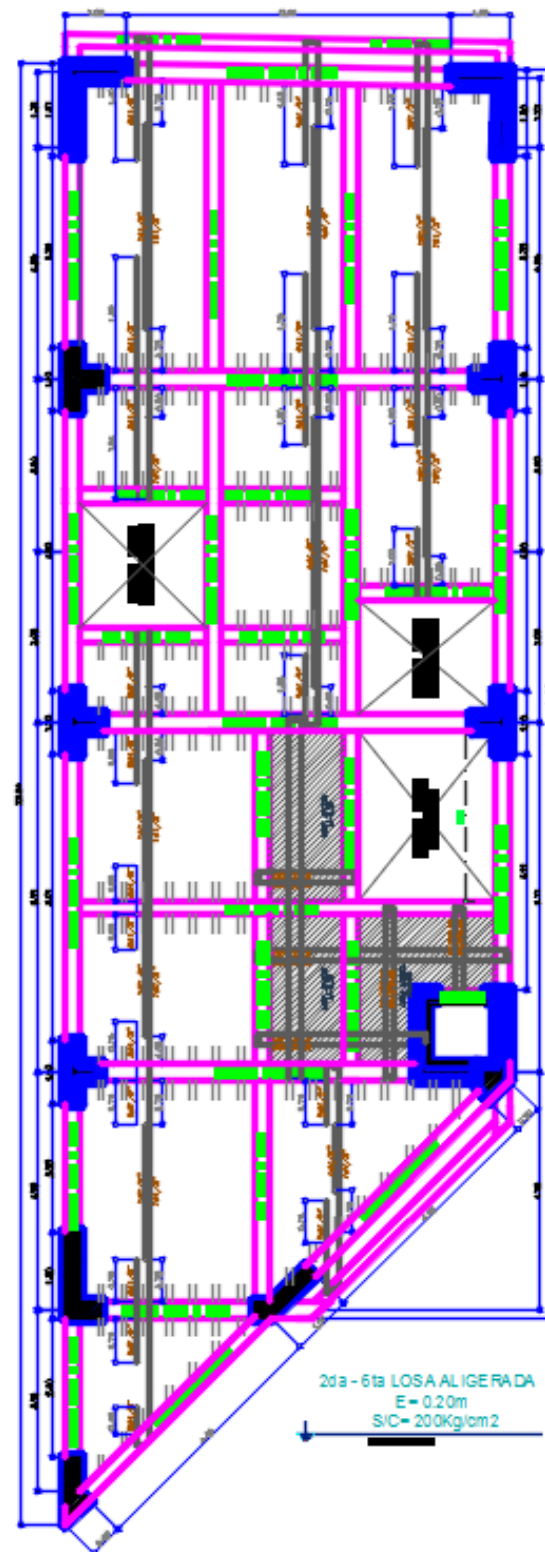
2da – 6ta losa aligerada del sistema de muros estructurales
